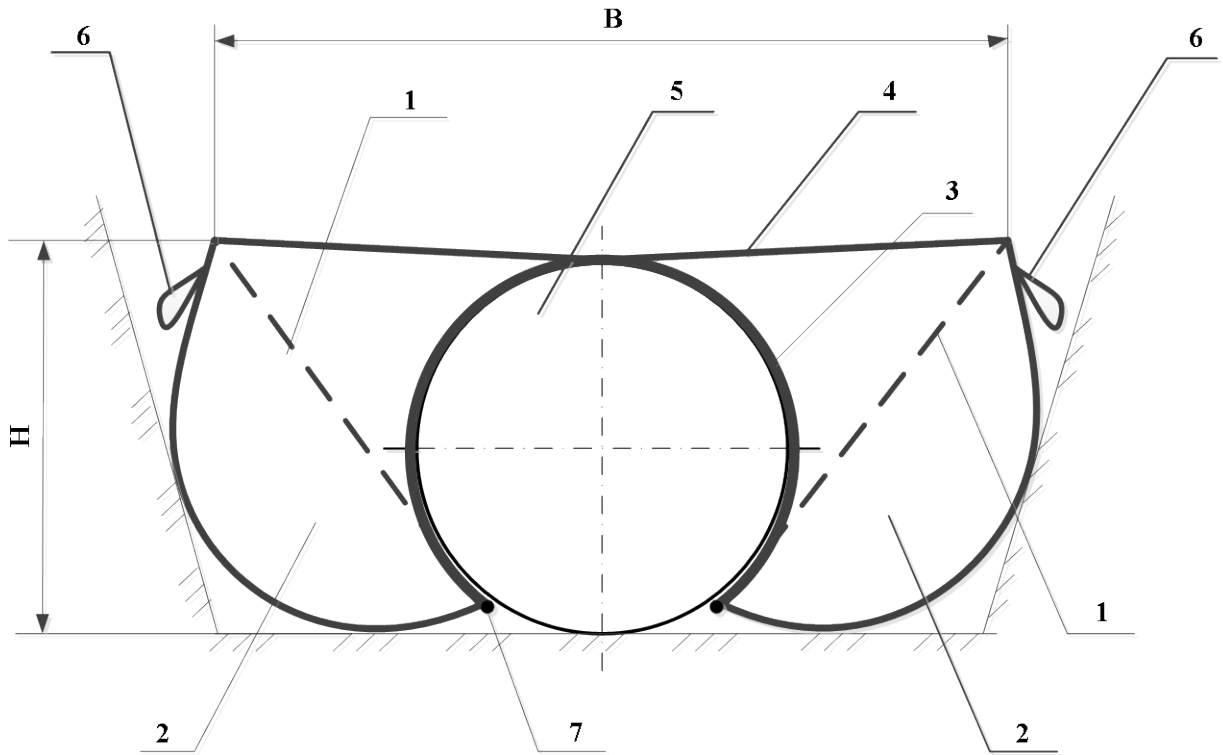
а Общий вид ПКБУ, заполненное грунтом и установленное на трубопровод
